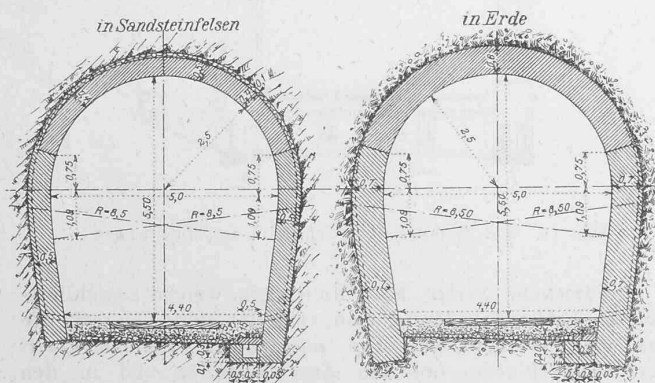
Tunnelprofile der Bern-Neuenburg Bahn. 1:150.
